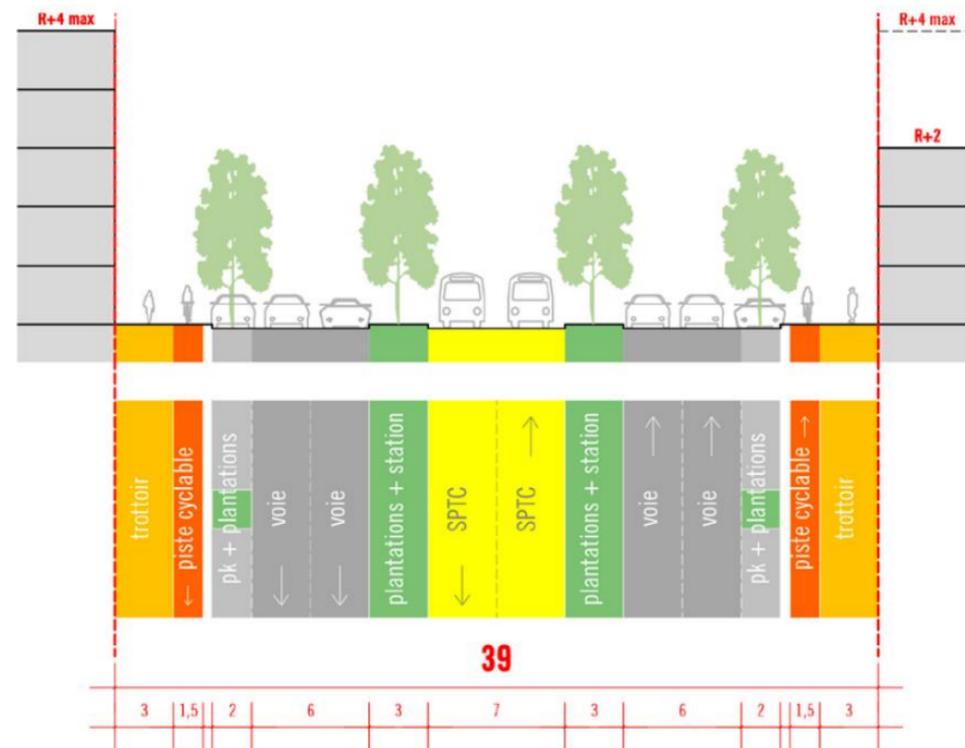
Profil en travers du Plan Directeur - Profil 39 m
